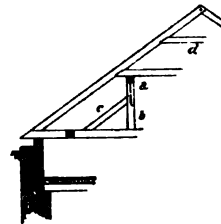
Querschnitt eines stehenden Dachstuhles. a Pfetten, b stehende Stuhlsäule, c Pfettenbüge, d Spizbalken.
